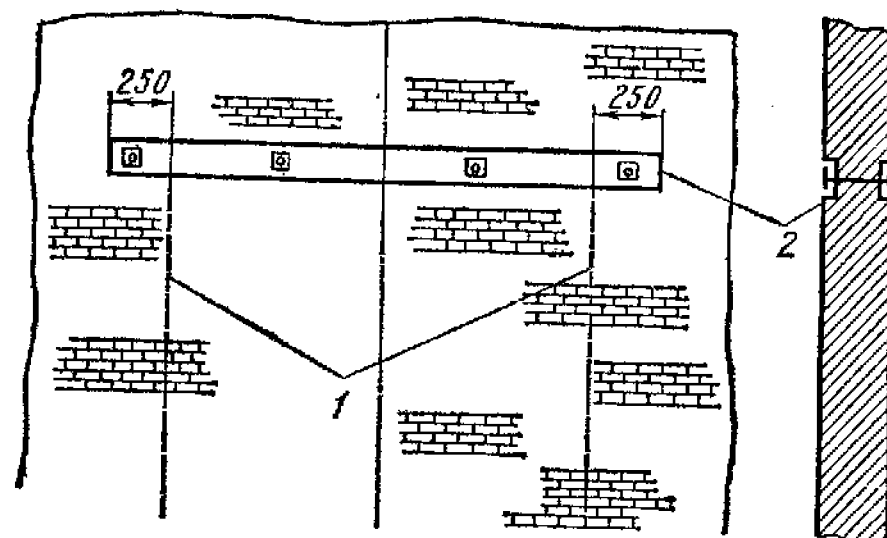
Схема закладки стальных балок перемычки при пробивке проемов в стенах:
